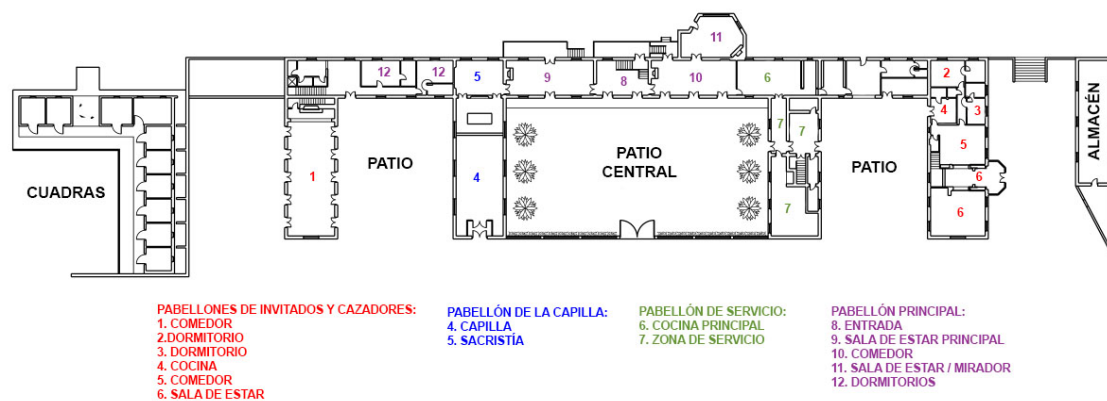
Plano planta baja de la casa de la Finca La Alcaría. Fuente: Elaboración propia en base a plano de AAVV (2002).
